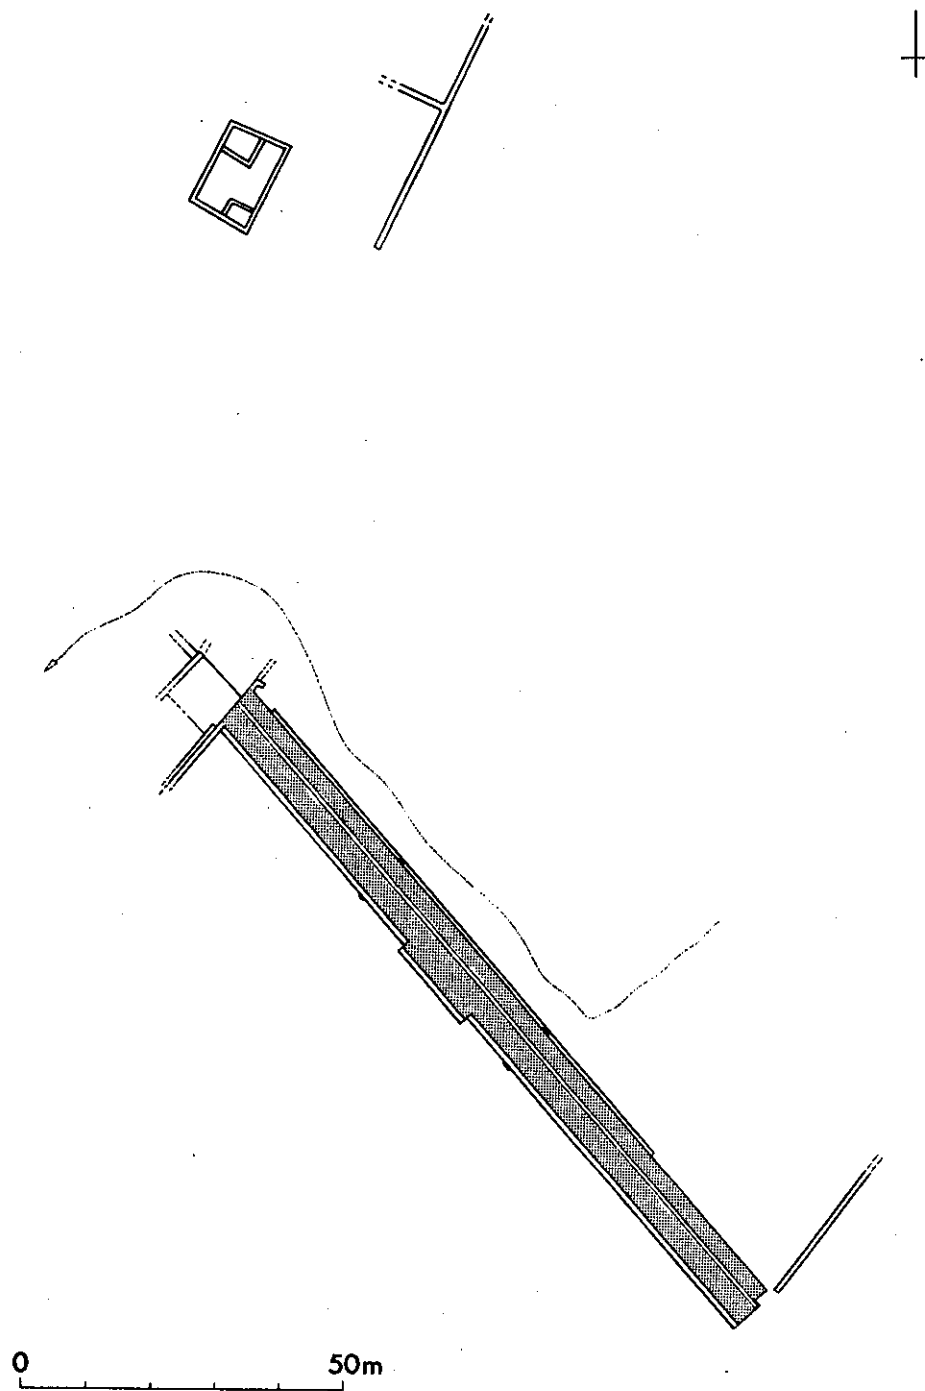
Wadi al-Qanatir. Plan du barrage amont.
